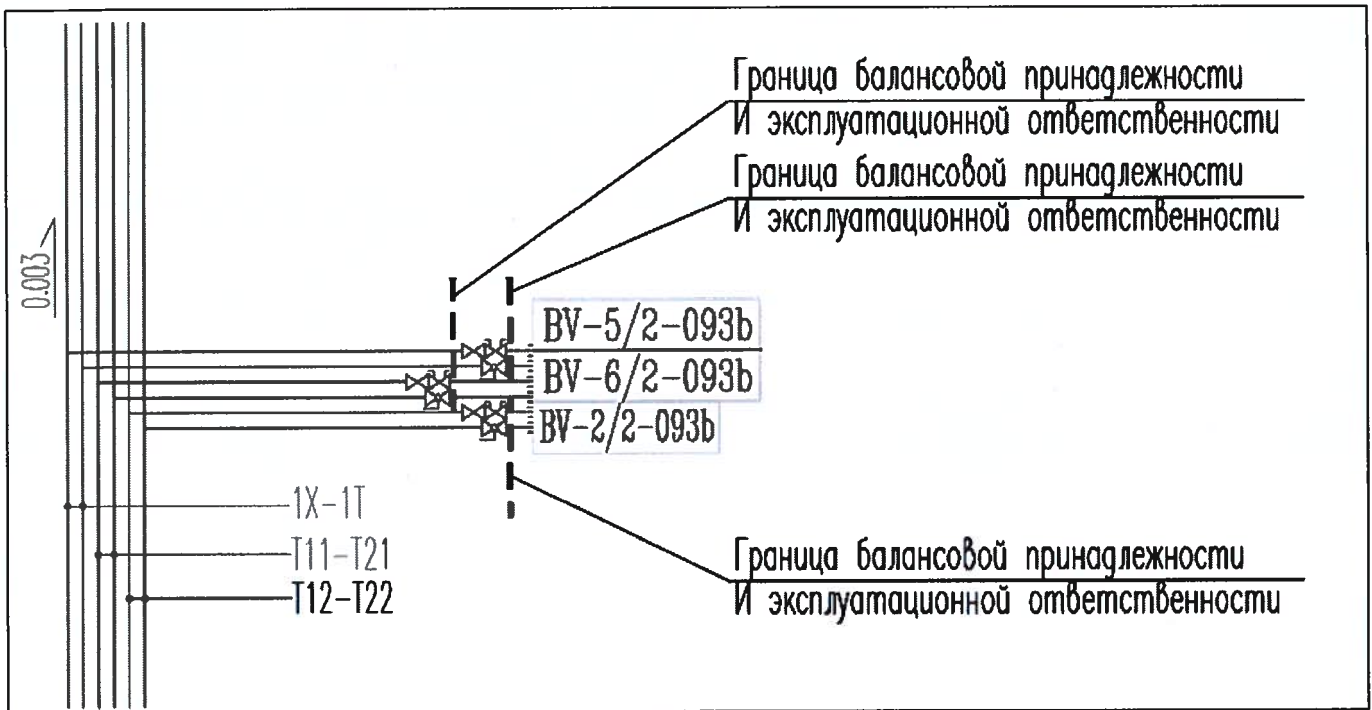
Принципиальная схема узлов типового подключения трубопроводов систем теплоснабжения отопления T11-T21, теплоснабжения вентиляции T12-T22, холодоснабжения системы кондиционирования воздуха 1X-1T.
